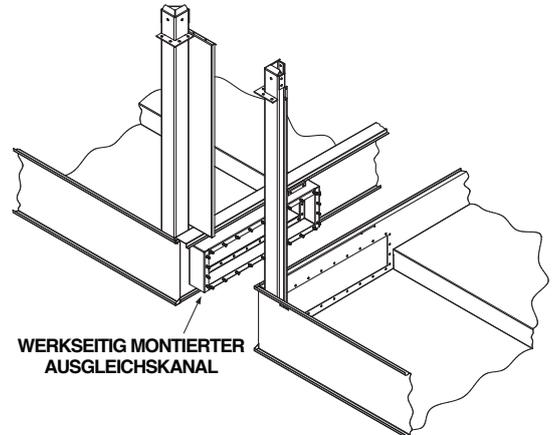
Montagedetails Ausgleichskanal, 12' (3.6 m) breite Modelle
